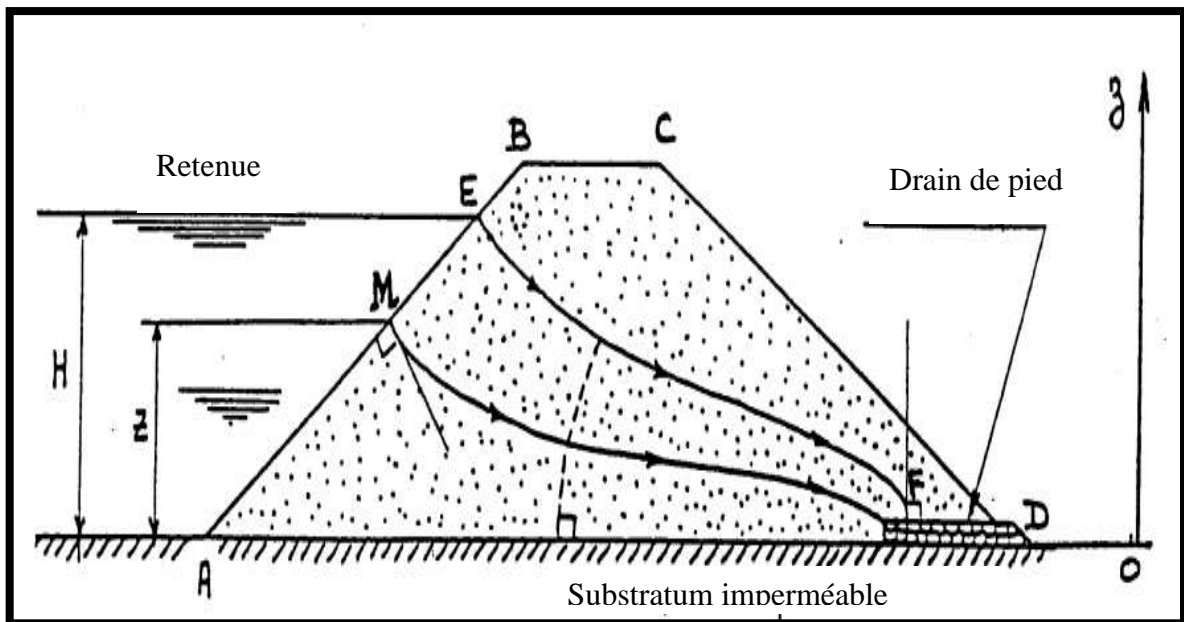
Barrage en terre homogène sur fondation imperméable
